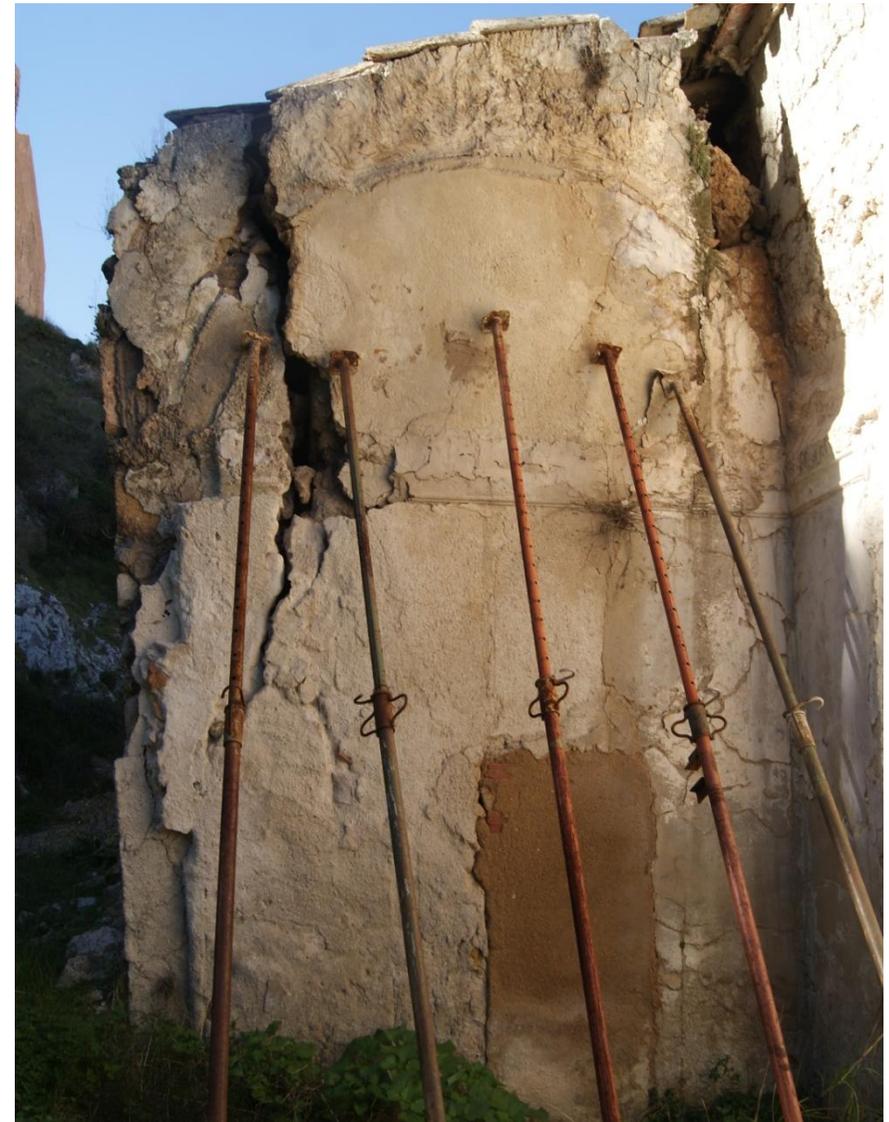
Grietas verticales en el muro de cierre de fachada sur. (David Clarí, 2014)
